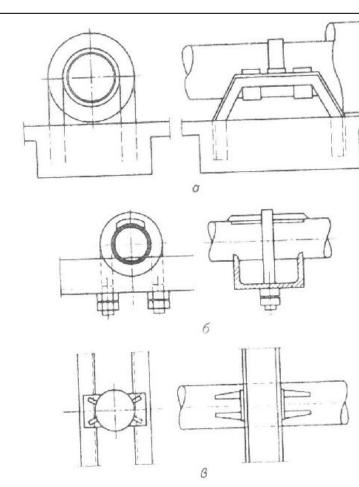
Неподвижные опоры a – на фундаментах; б – на балке; в – на стойках
